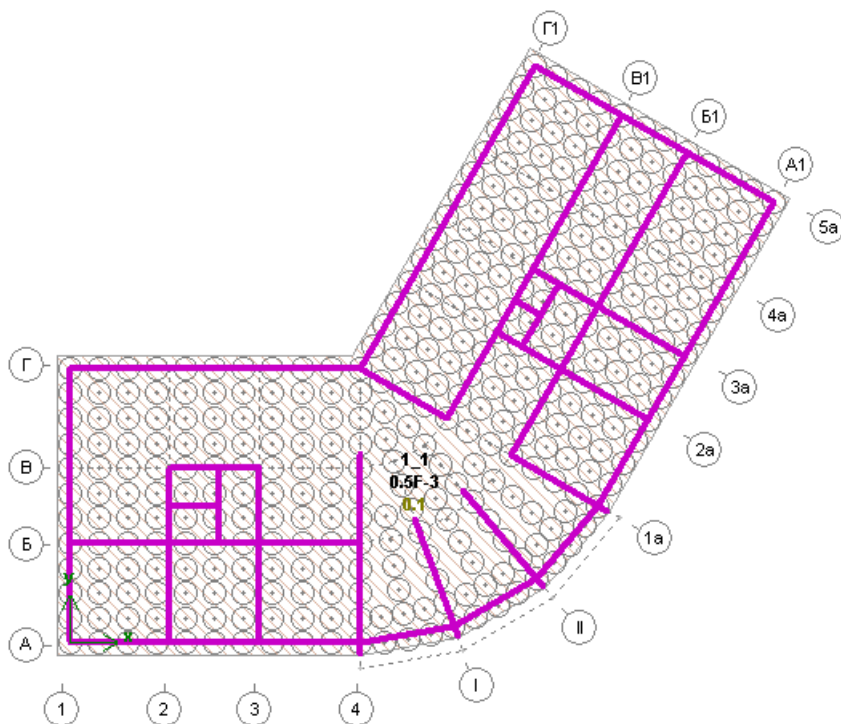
Фундаментная плита №1_1 на свайном поле
